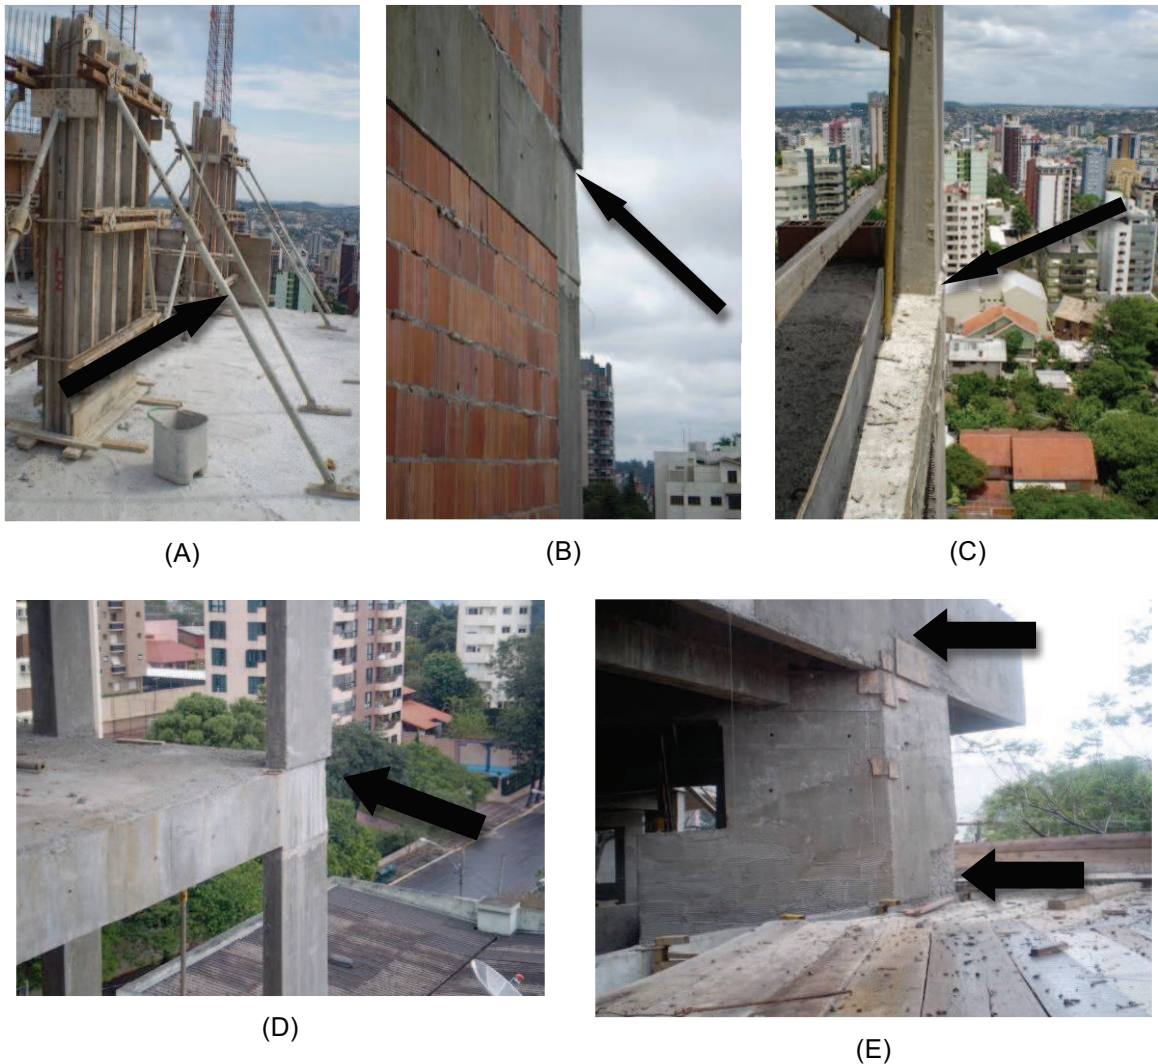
(A) Escoramento Metálico. (B) Falha Geometria da Fôrma da Laje. (C) Falha locação Pilar. (D) Falha Locação Pilar. (E) Escarificação por deformação da Fôrma.
